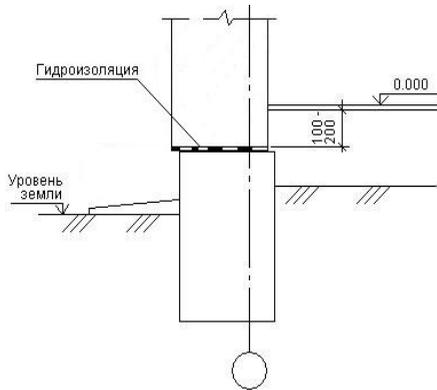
Расстояние от пола первого этажа до обреза фундамента
